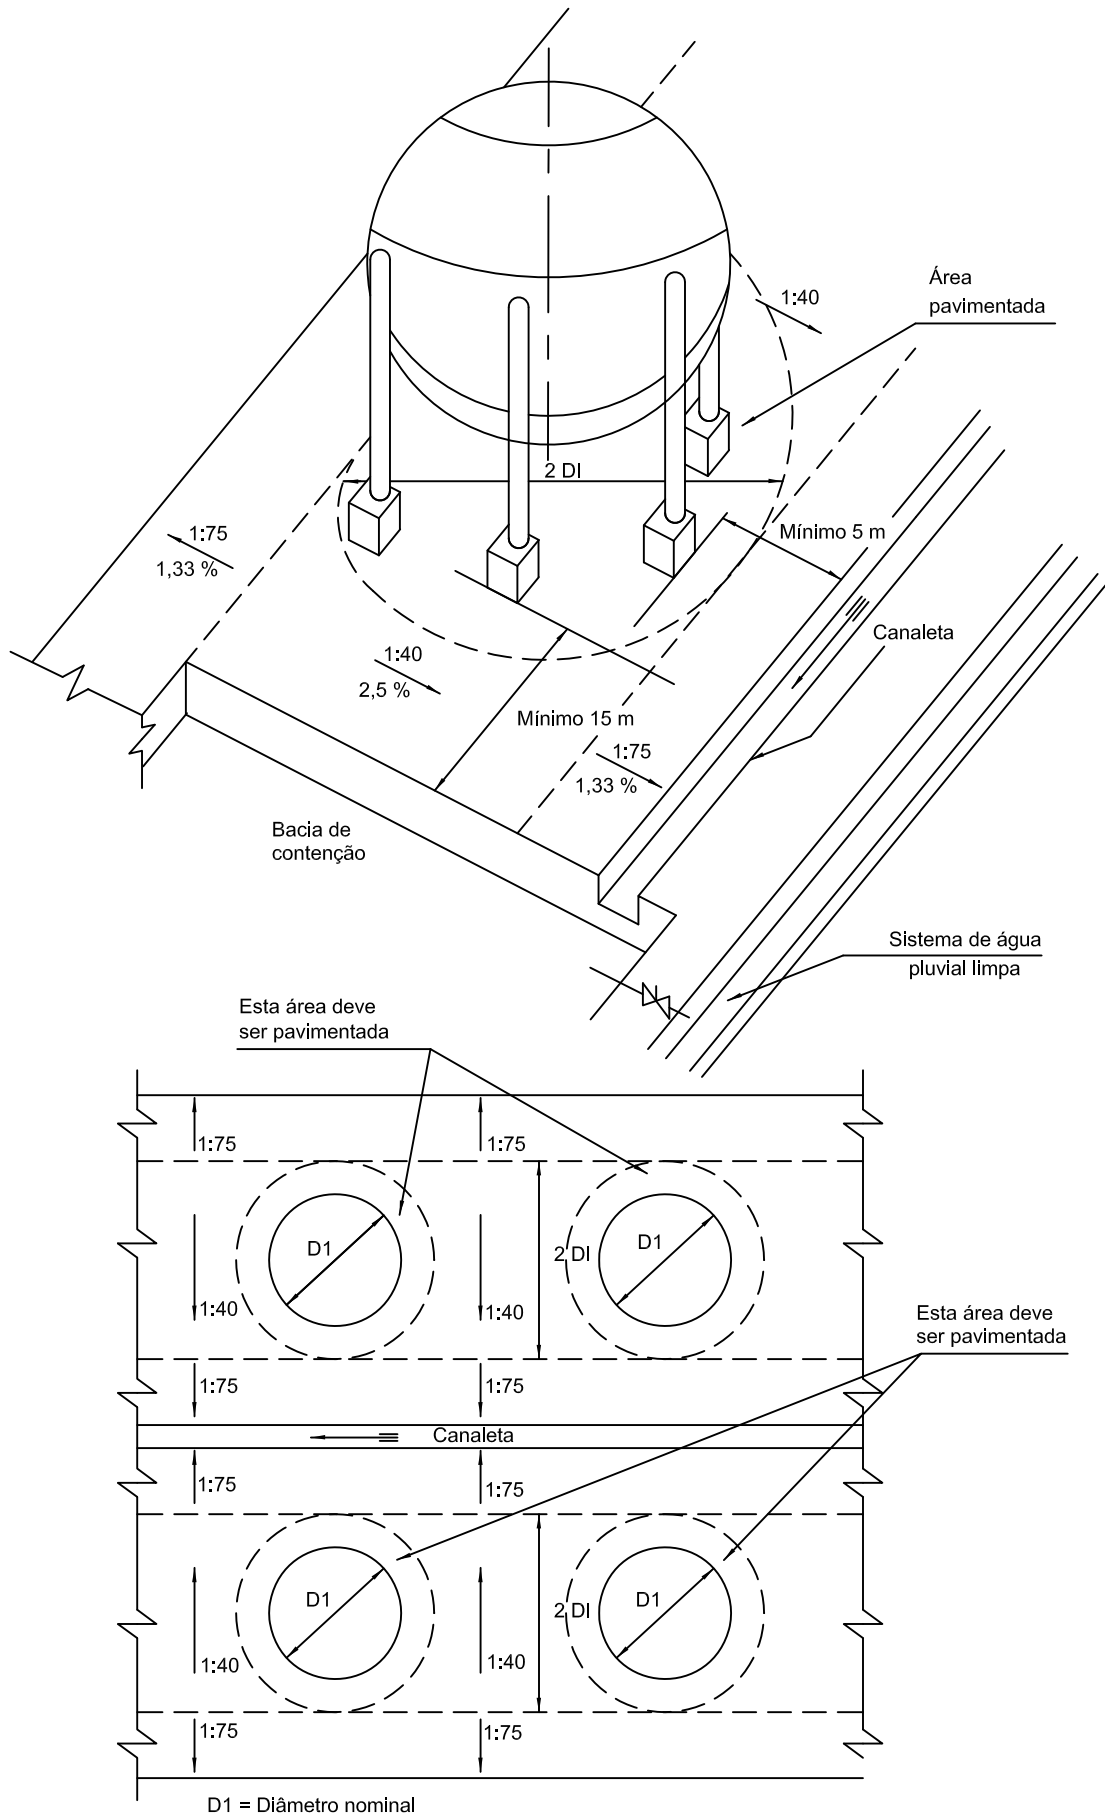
Pavimentação sob Esferas e Sistema de Drenagem Superficial
